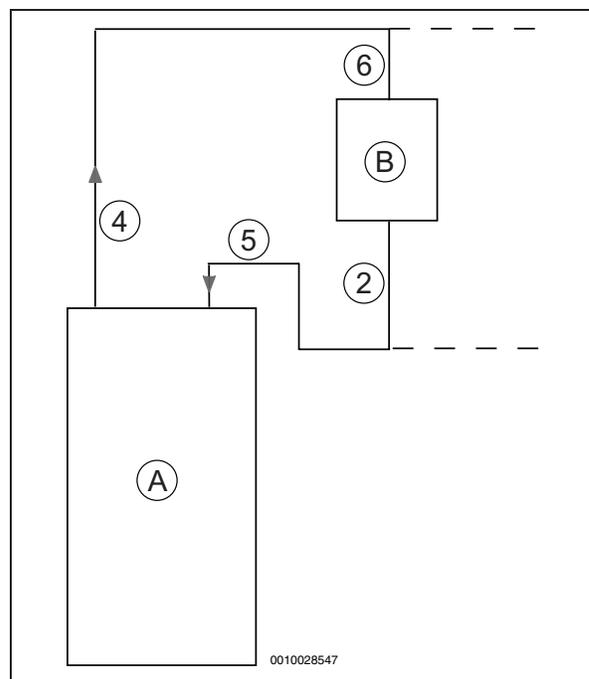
Prinzipskizze – Pufferspeicher mit Wärmepumpe
